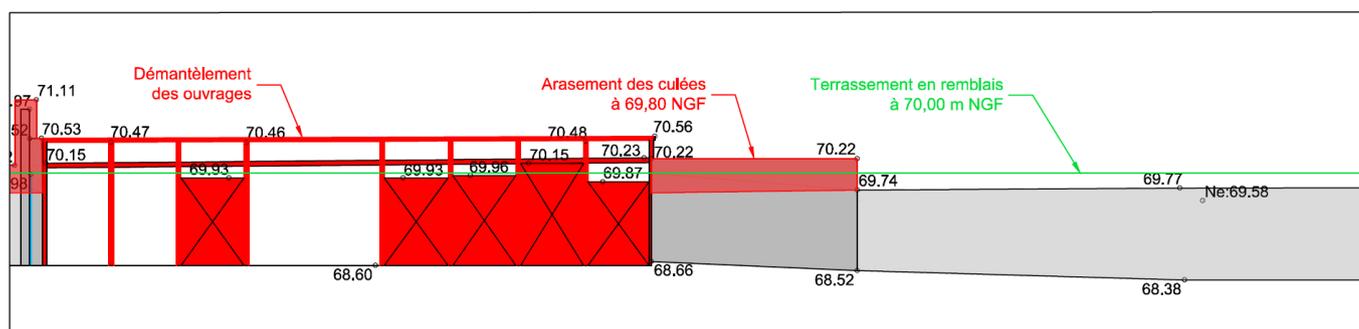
Profil en travers au droit de l'ouvrage du bief rive droite (PT10)
